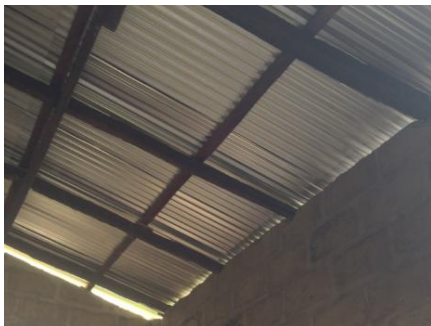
Detall constructiu de la tipologia de coberta actual.
